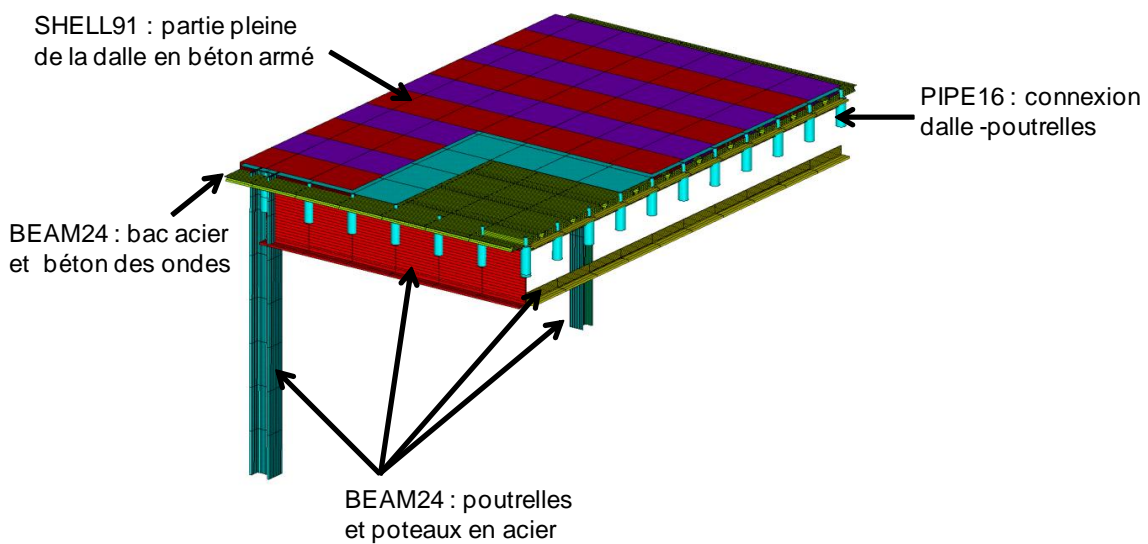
Vue « éclatée » du maillage de plancher mixte
